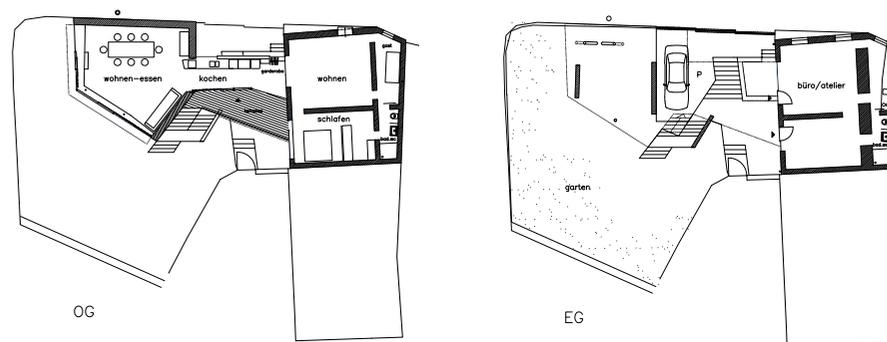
Grundriss Obergeschoss und Erdgeschoss
